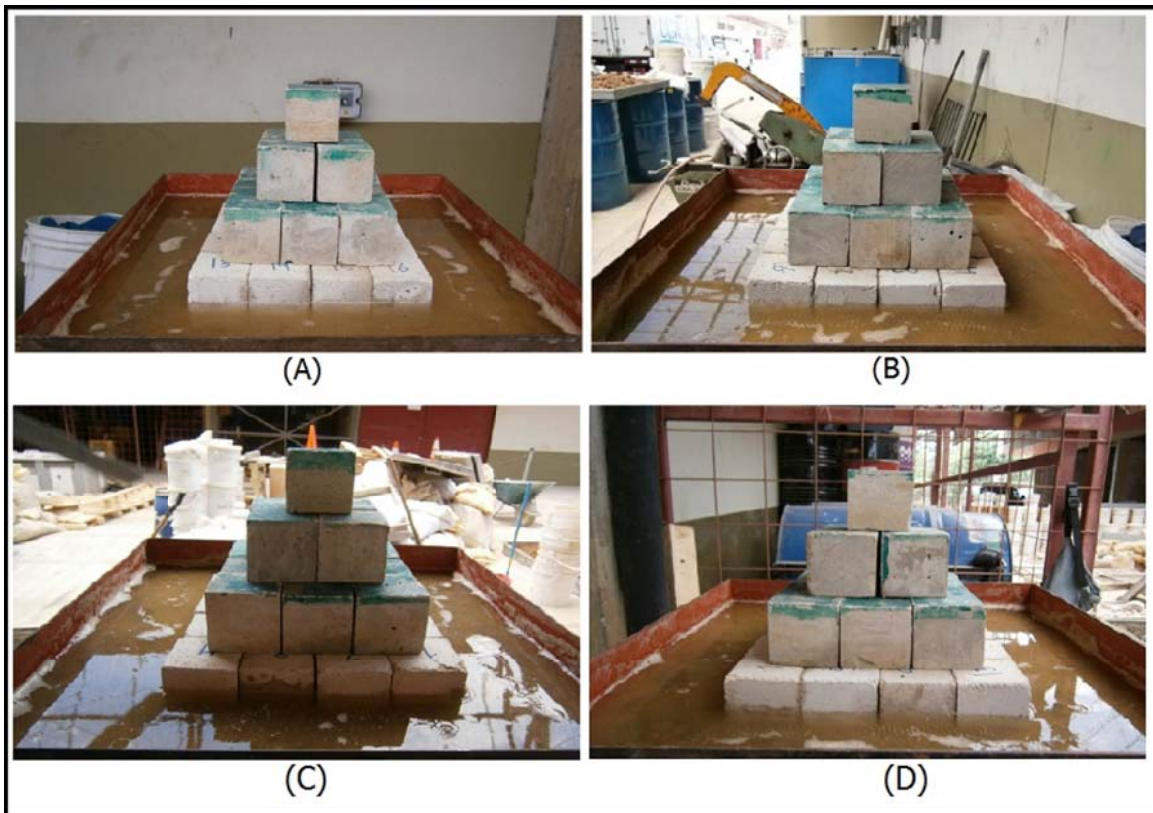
Resultado del modelo a escala combinación 75/25. (A) Fachada norte, (B) fachada este, (C) fachada sur, (D) fachada oeste
